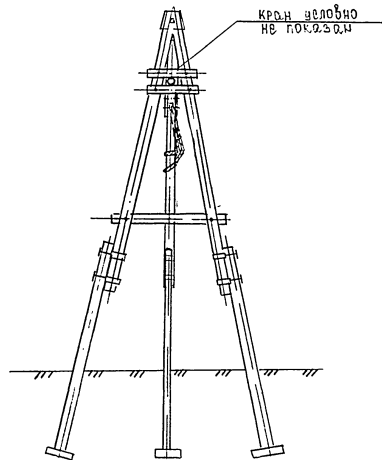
, вариант 1. Демонтаж опоры с паринками строповка А-образной фермы и разработка котлованов.
